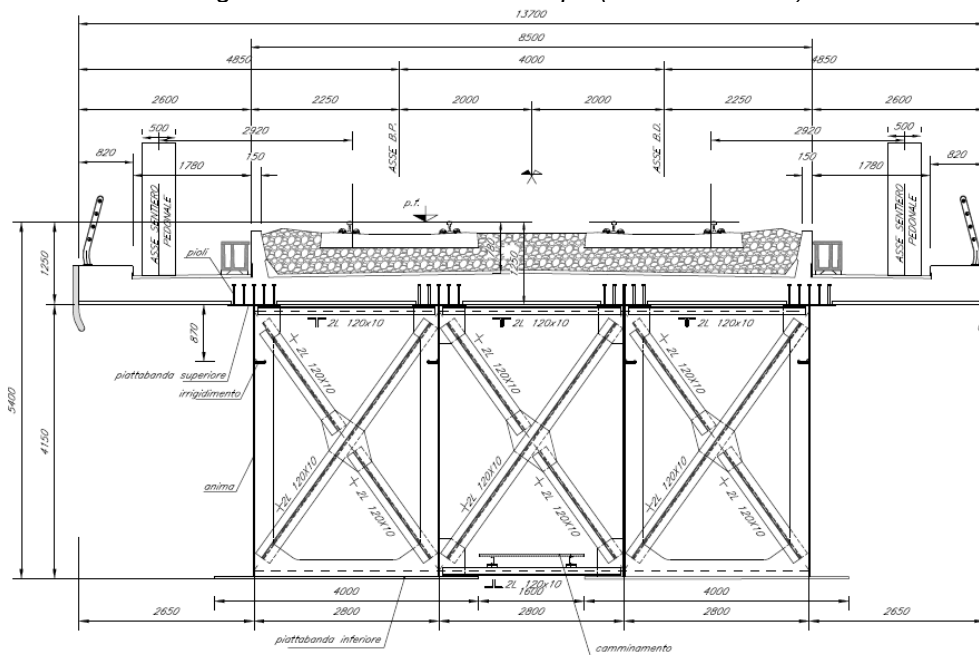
Sezione trasversale tipo ( $H$  travi = 4.15)
